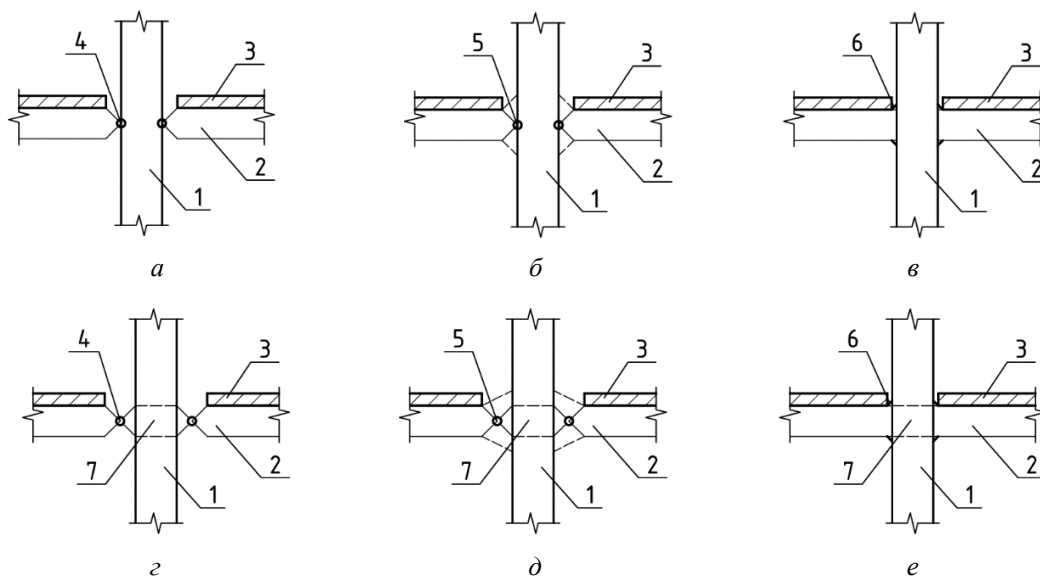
Схеми конструктивних форм з'єднання ригелів перекриття з трубобетонною колоною: 1 – трубобетонна колона; 2 – ригель перекриття; 3 – плита перекриття або настил; 4 – шарнірне з'єднання ригеля з трубобетонною колоною; 5 – податливе з'єднання ригеля з трубобетонною колоною; 6 – жорстке з'єднання ригеля з трубобетонною колоною; 7 – елемент, що перетинає бетонне ядро трубобетонної колони
